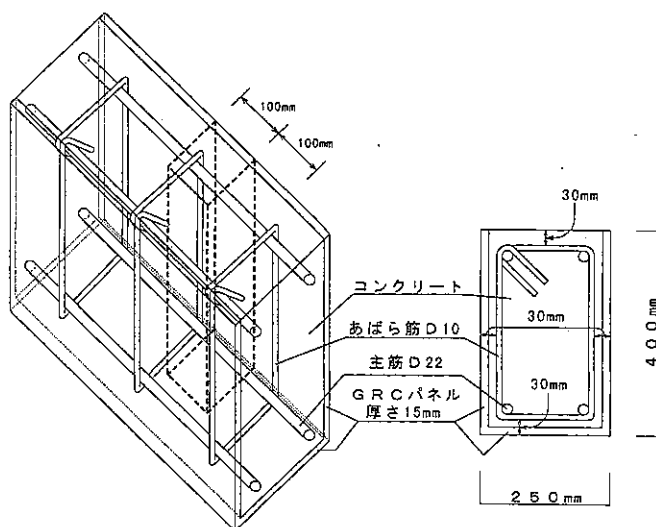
GRC打込み型枠使用鉄筋コンクリートはり構造図
